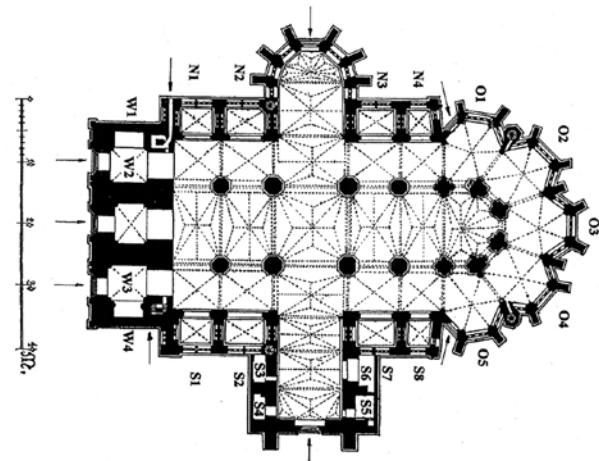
Rostock, St. Marien, Grundriss
